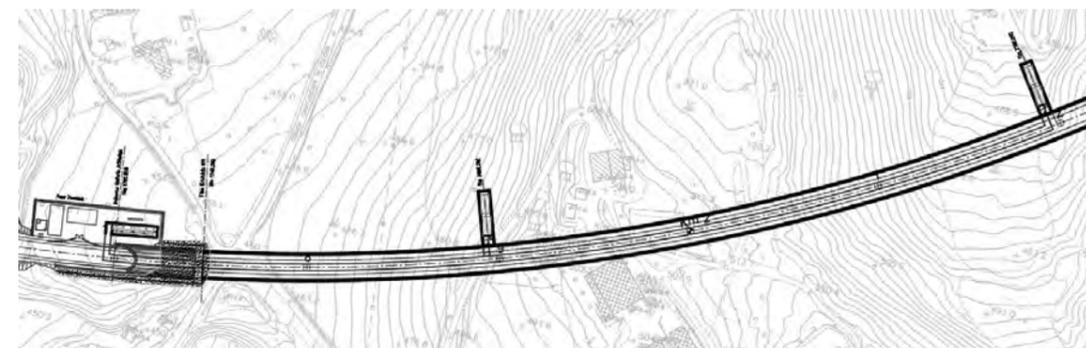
Stralci planimetrici della galleria "Mercatello 2" - 1° parte
